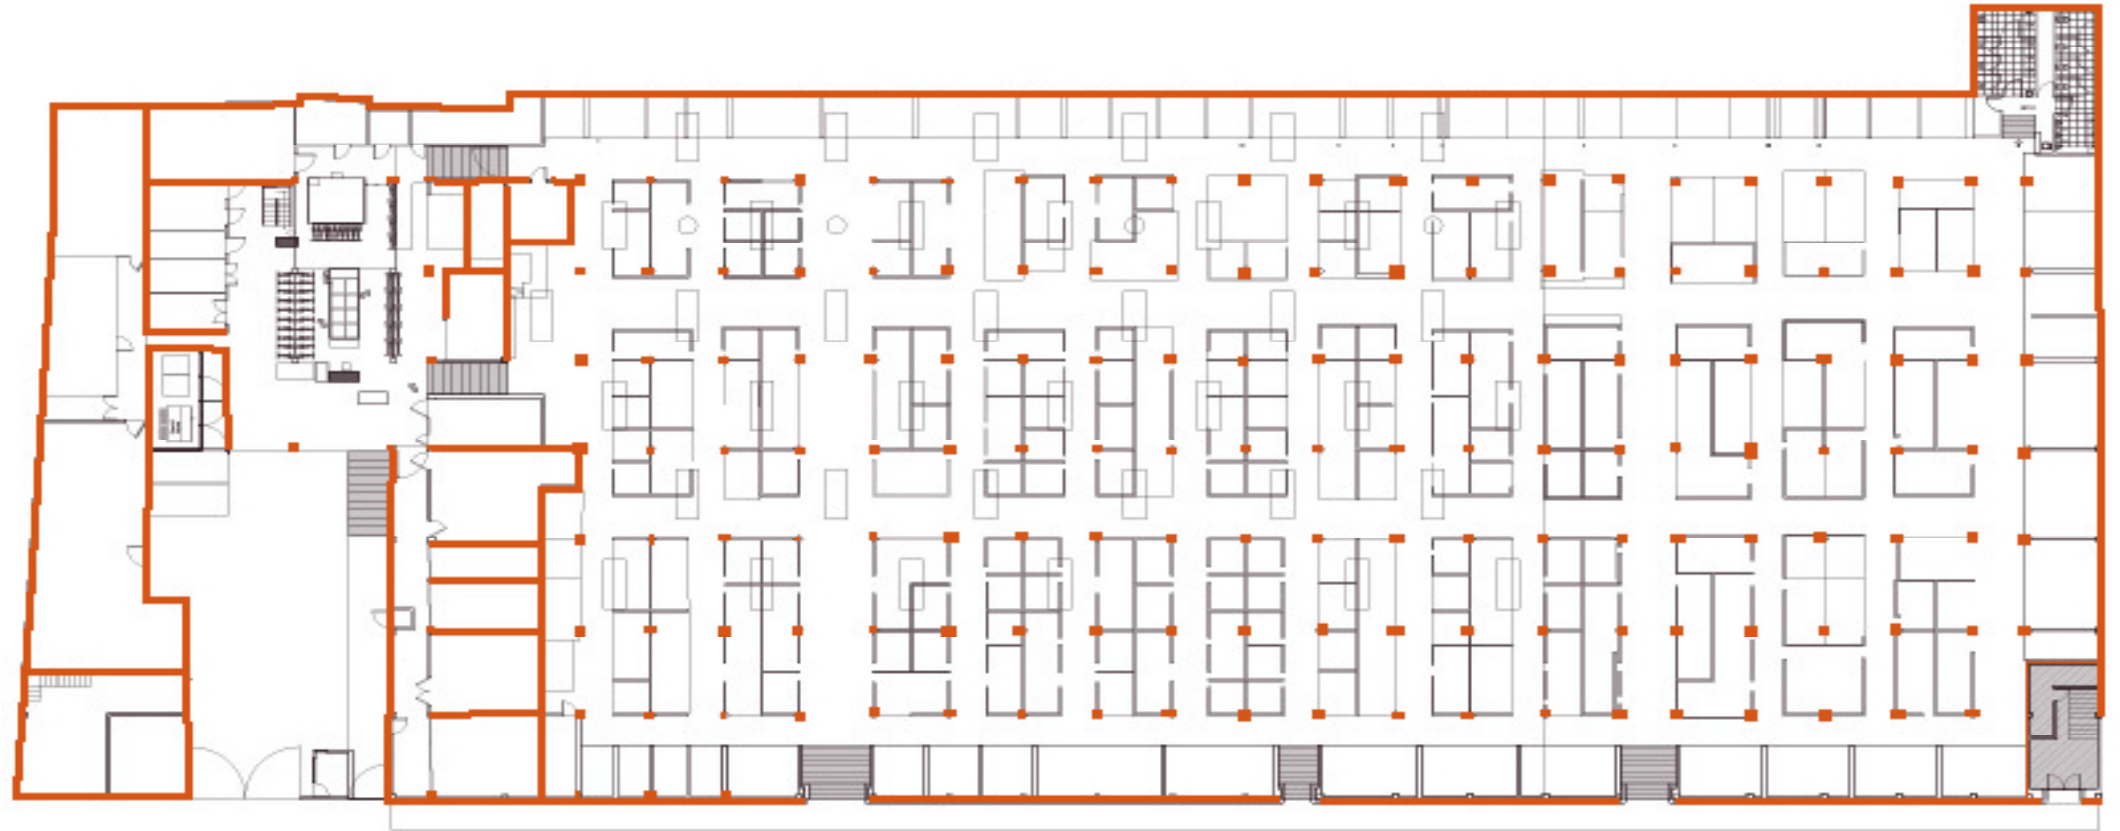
Ubicación de Columnas y Elementos de Cierre.
